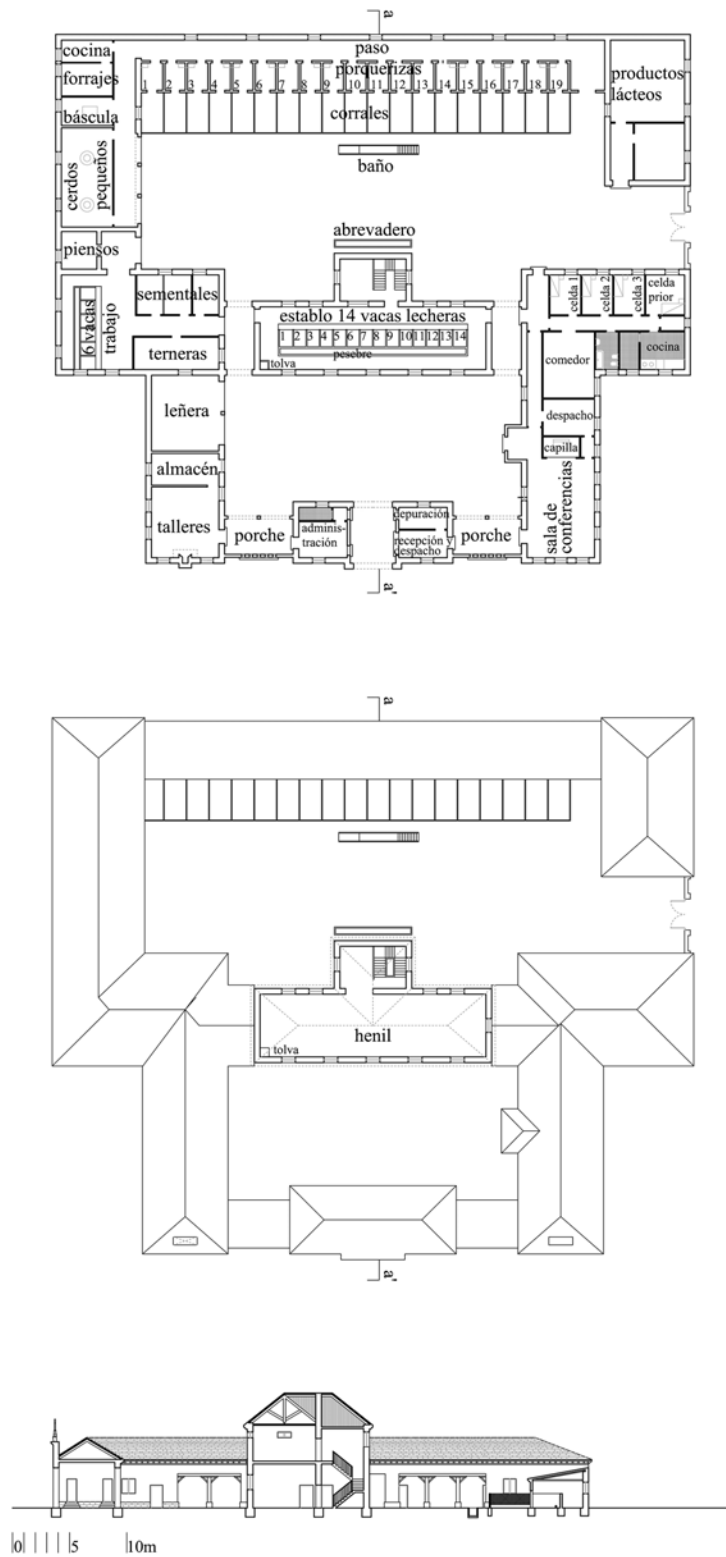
PLANO DE PLANTA BAJA, PLANO DE PLANTA ALTA Y DE CUBIERTAS Y SECCIÓN AA' DEL PROYECTO DE GRANJA ESCUELA DIBUJADO POR MIGUEL DURÁN EN 1945. PLANOS ELABORADOS POR LA AUTORA TOMANDO COMO BASE LOS ORIGINALES CONSERVADOS EN EL ARCHIVO DE LA FUNDACIÓN ALEJANDRO DE LA SOTA, N.º REFERENCIA: 47-A.
